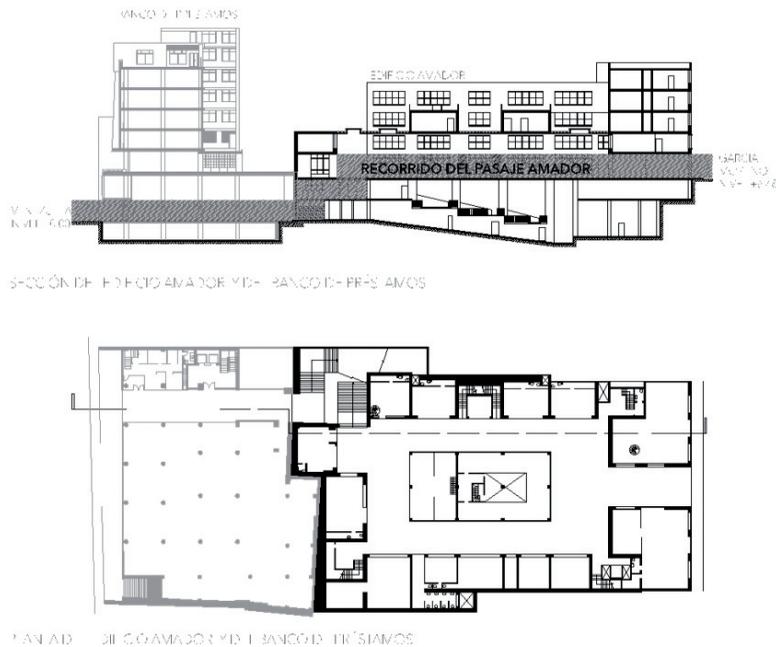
Planta general. Conexión con el Banco de Préstamos.
